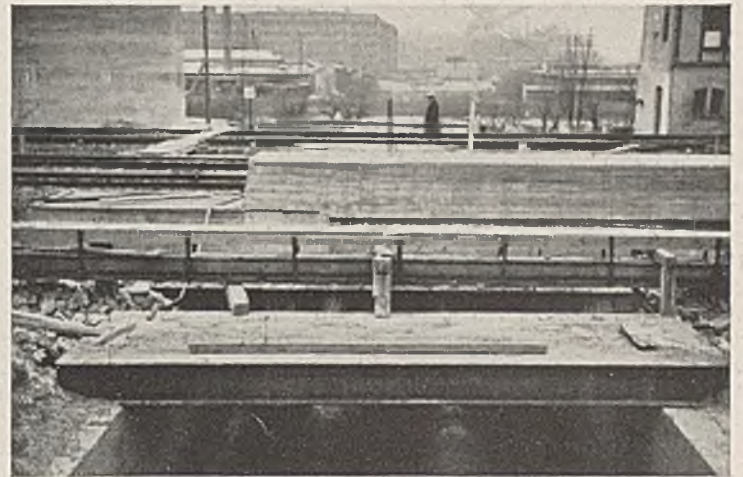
Kreuzung des Rohrtunnels mit der Bahn.
